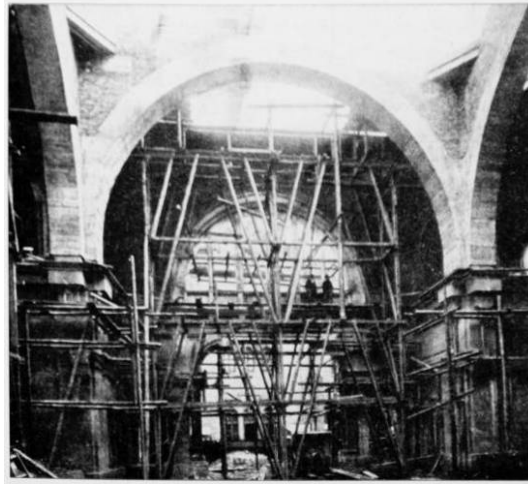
Arcos de hormigón armado cúpulas de la Estación Central de Nürenberg, 1900.
